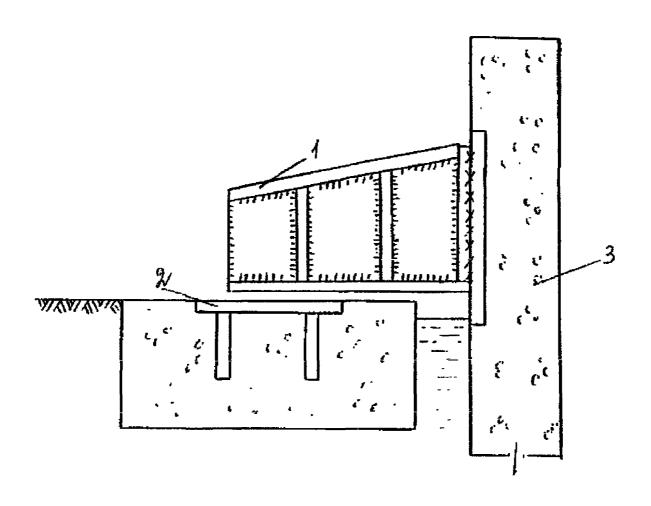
Пример конструкции упора I ; 2 — закладные пластины; 3 — стена колодца
